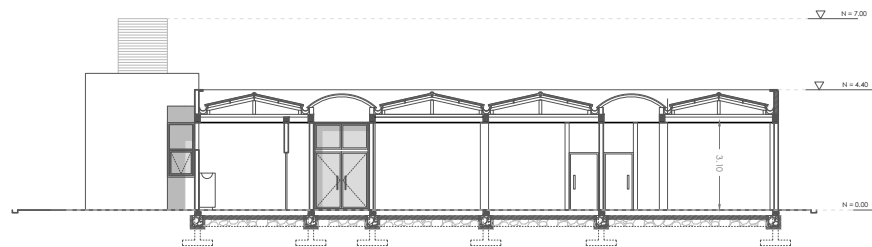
Elevaciones fachadas Norte-Sur-Este-Oeste IPCA
